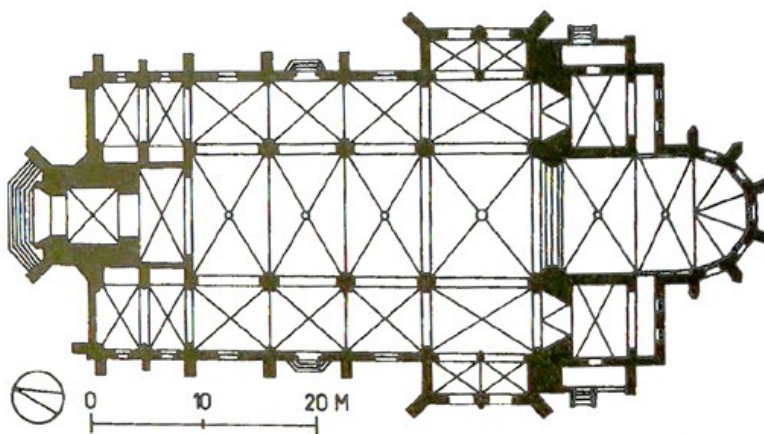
, Elisabethkirche Wien 4. Grundriss, reproduziert nach Dehio 2014.
